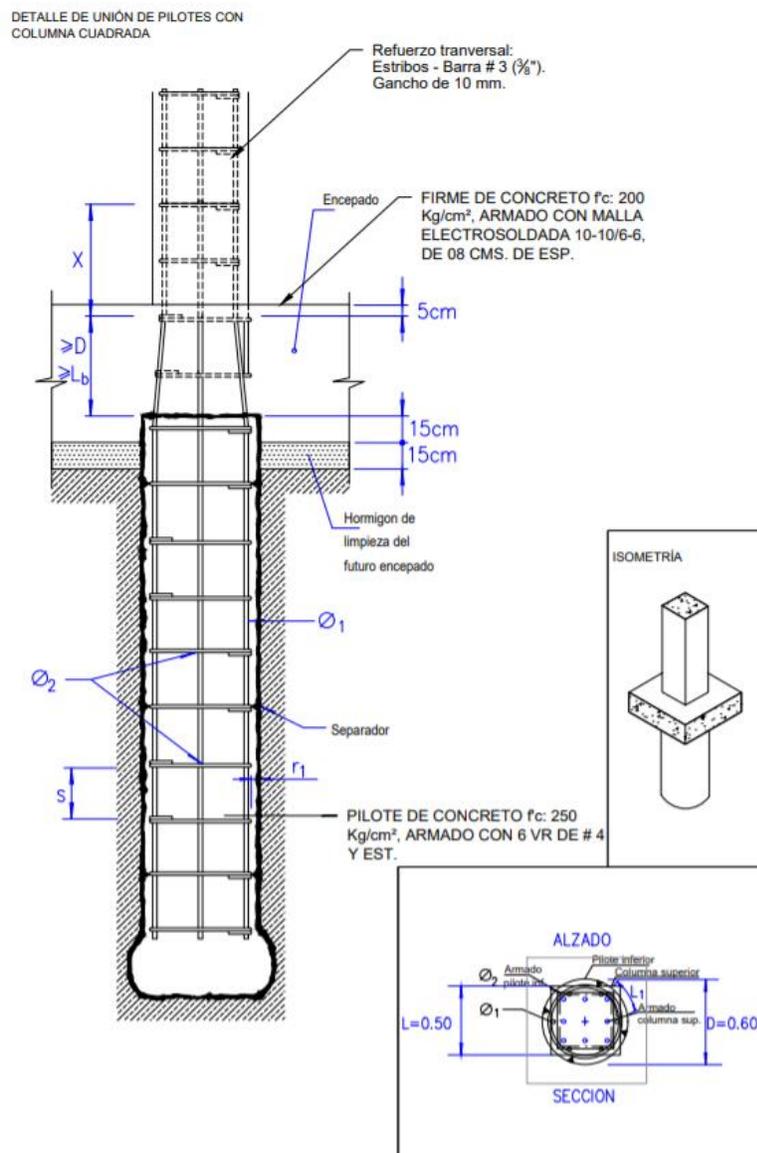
Detalle de unión de pilotes con columna cuadrada.
